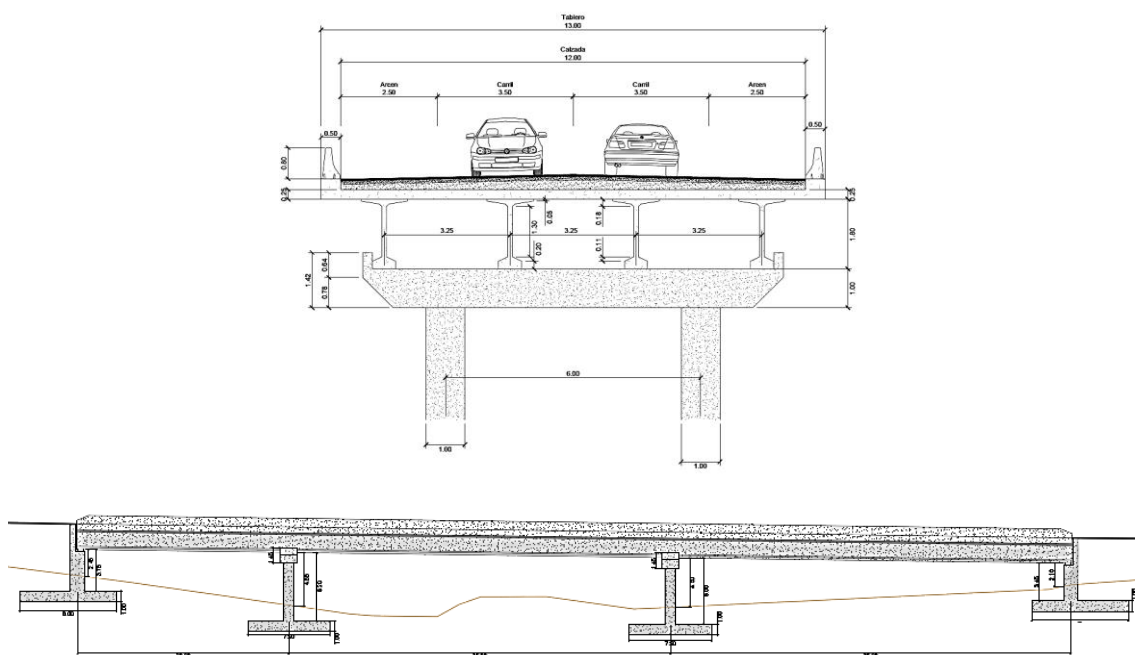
Sección tipo y sección longitudinal del Puente 3
